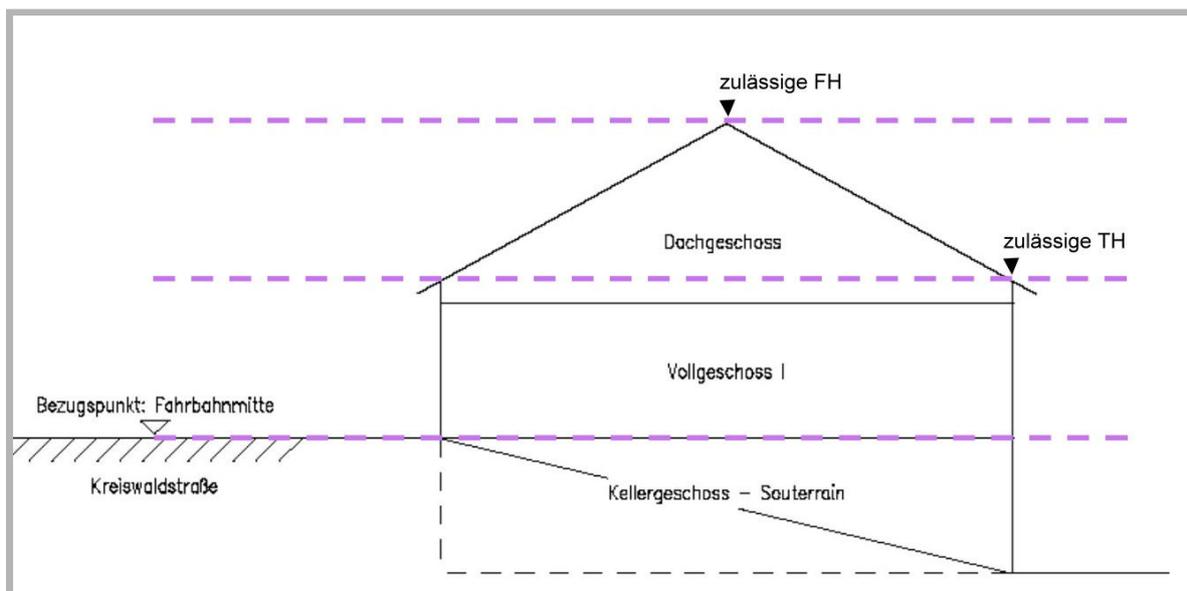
Planskizze zur Erläuterung der Bauhöhenbezüge und -festsetzungen
